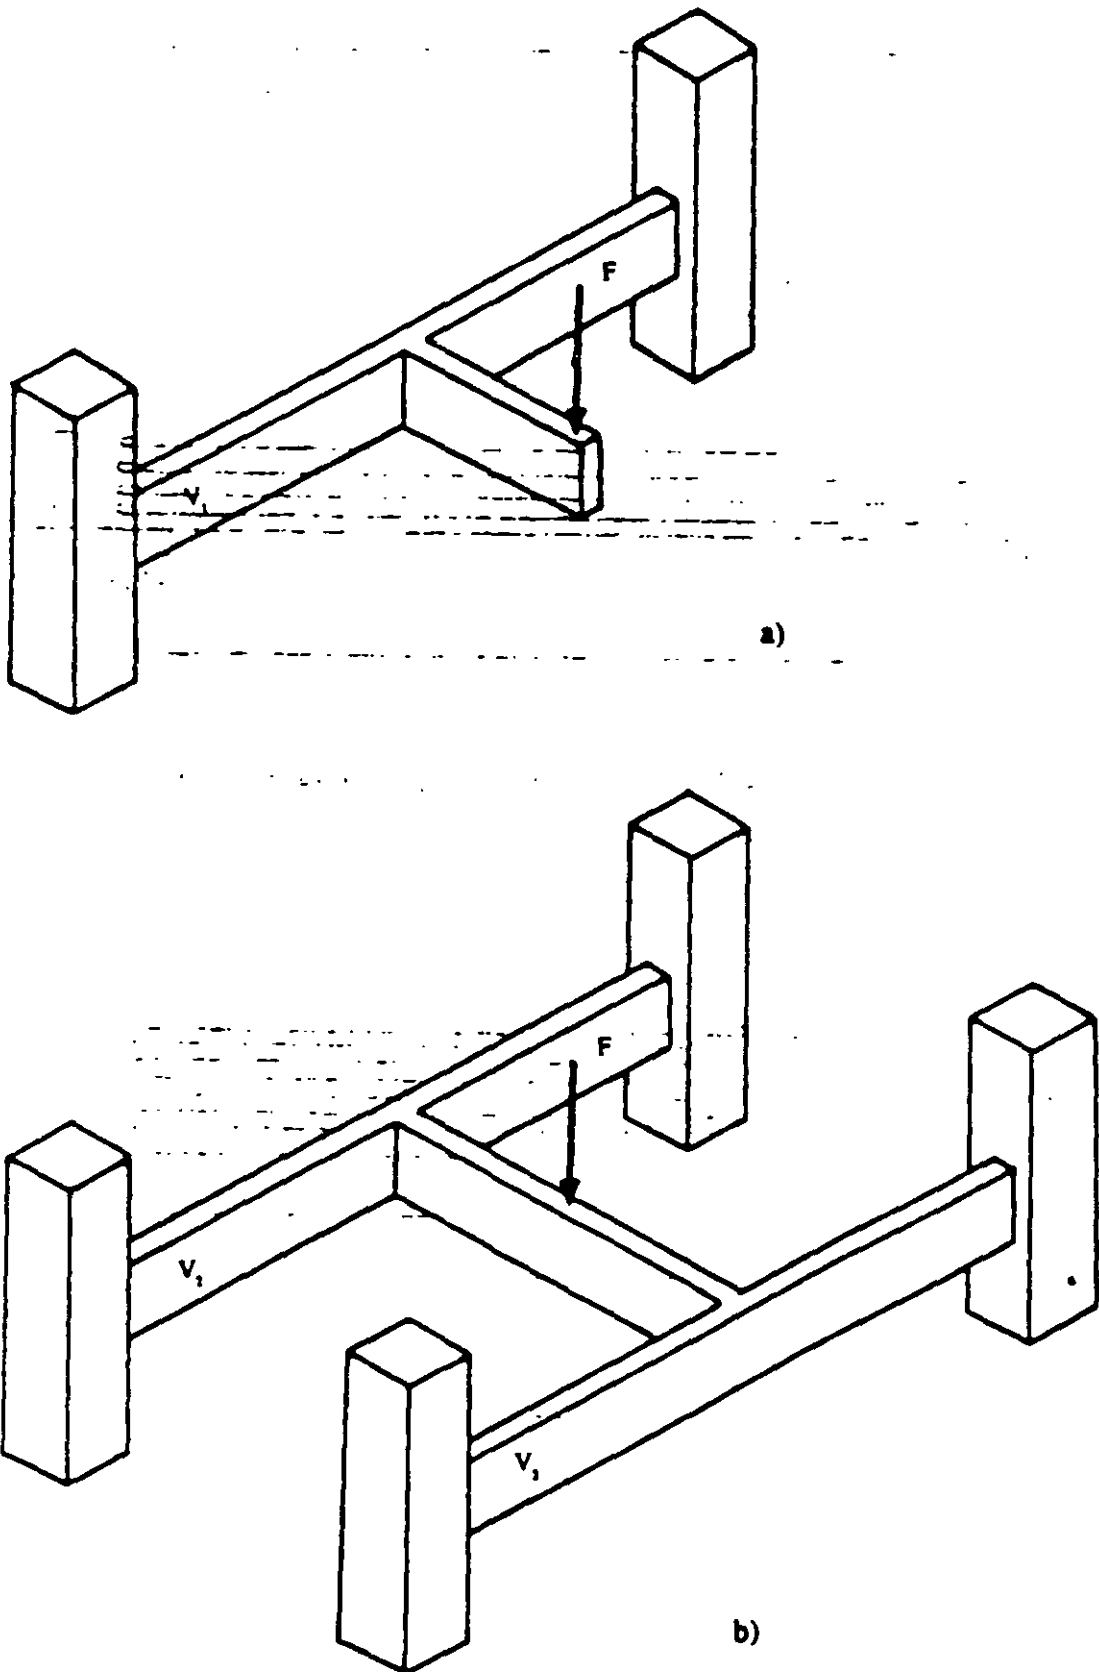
Ejemplos de vigas en las que existe torsión (vigas v , y v_1).
